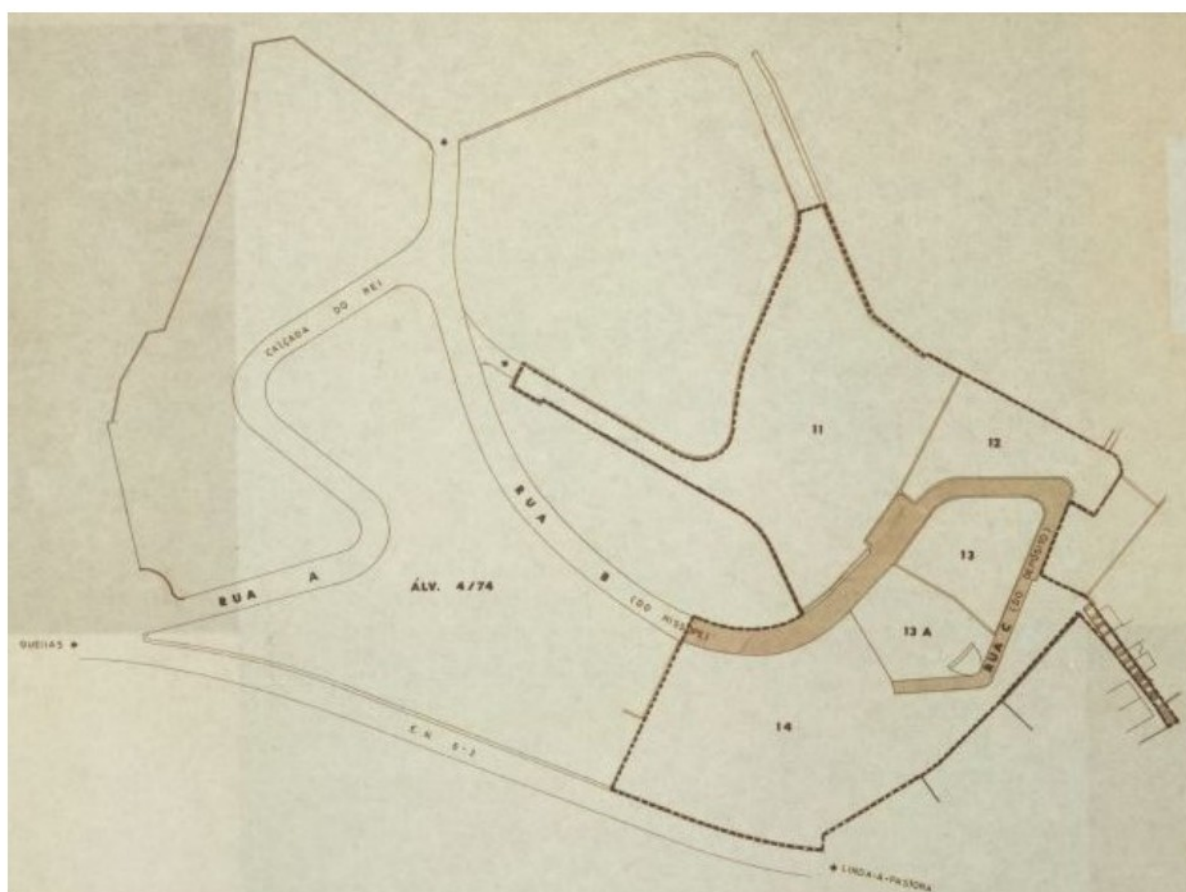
Planta Síntese do Alvará de Loteamento n.º 11/1976 em vigor
